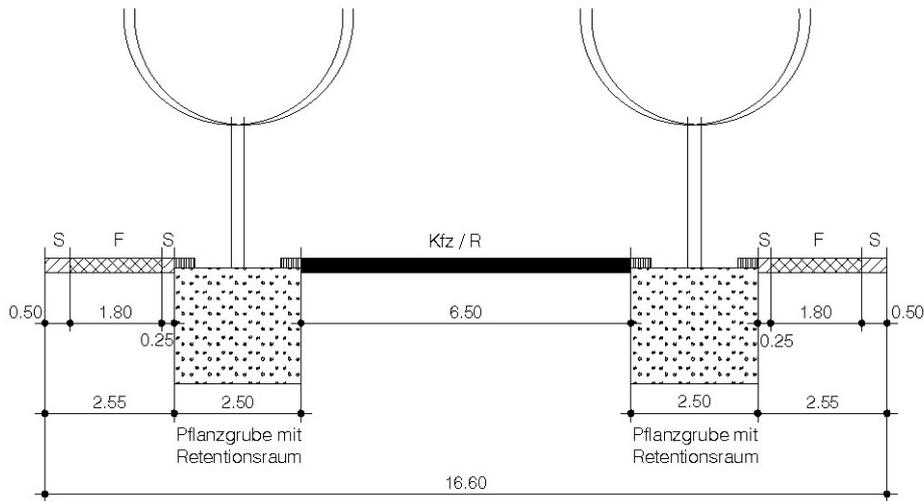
empfohlener Straßenquerschnitt für die Planstraße „A“
